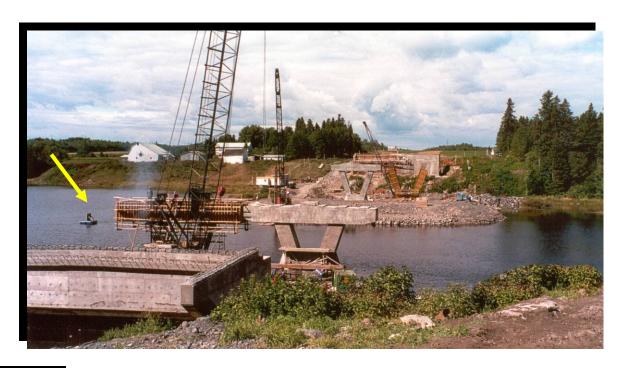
Balise installée conformément à la Loi sur la protection des eaux navigables. Autoroute 70 à Jonquière, pont de la rivière aux Sables. (2000.1046)
